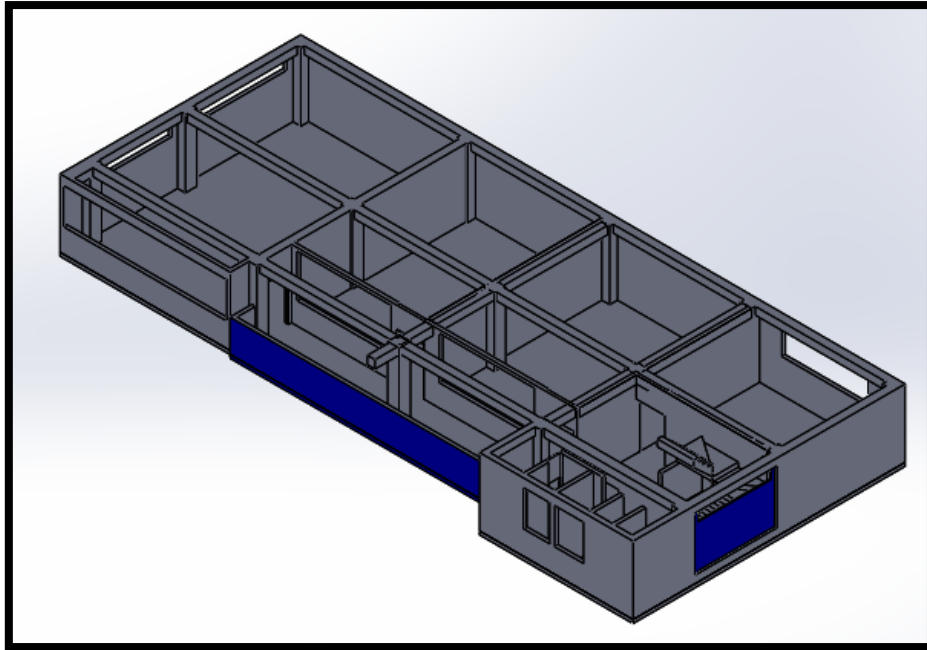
Diseño 3D de la primera y segunda planta alta el Bloque 3
